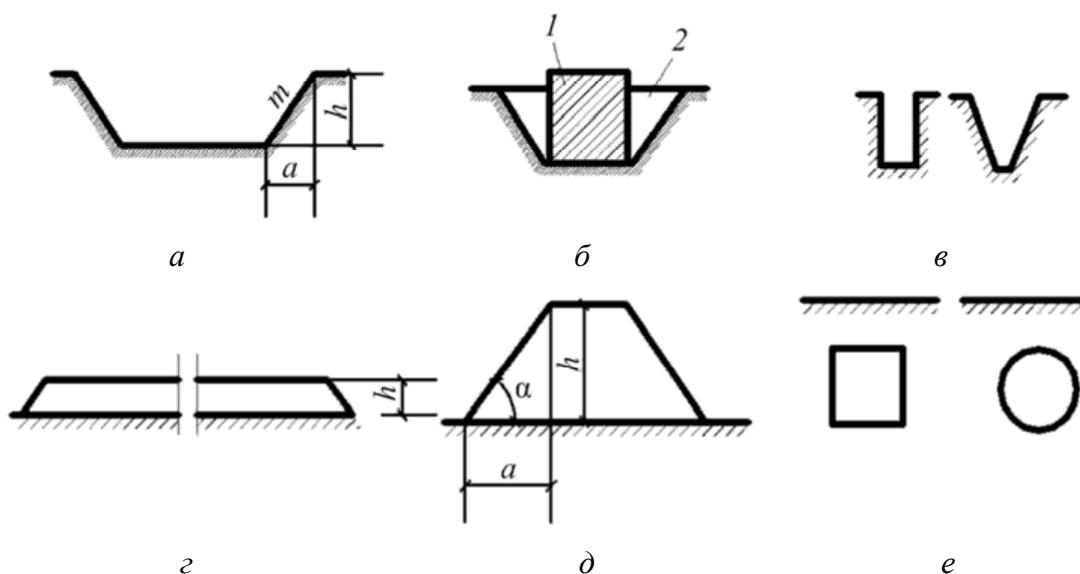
Виды земляных сооружений: *a* — открытый котлован, поперечный профиль; *б* — закрытый котлован, поперечный профиль; *в* — траншея, поперечный профиль; *г* — планировочная насыпь, профиль; *д* — земляное полотно дороги, профиль; *е* — подземные выработки, сечения: 1 — здание (сооружение); 2 — обратная засыпка
